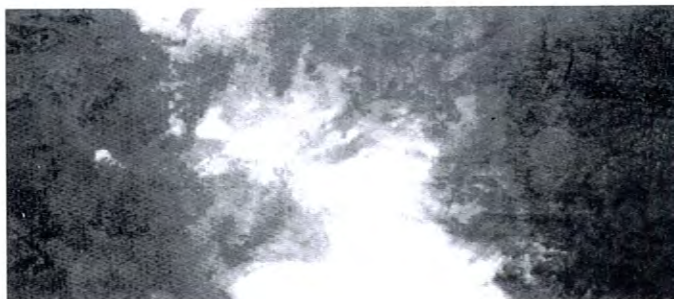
Aspetto di una lamiera anodizzata ed elettrocolorata dopo contatto in cantiere con una soluzione fortemente alcalina (foto tratta dalla pubblicazione CIOA *Difetti dell'alluminio e dell'alluminio anodizzato*)
